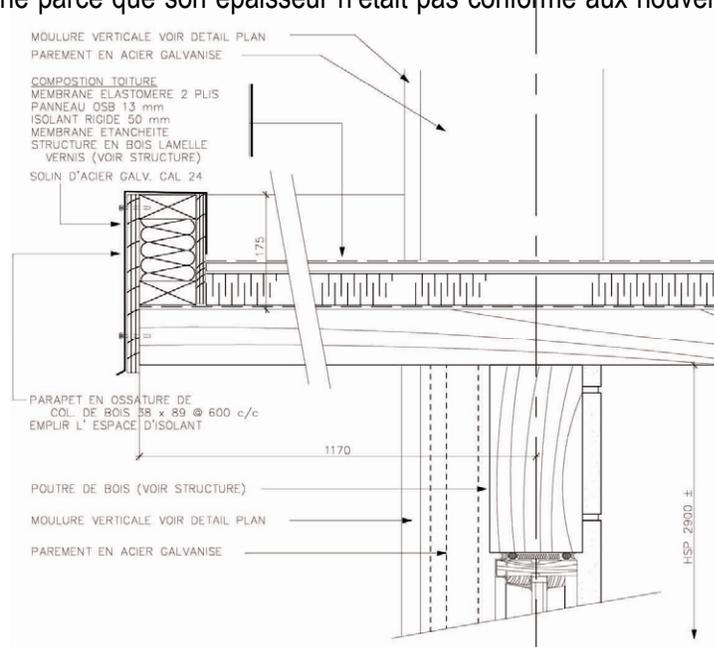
Détail de la toiture de planchéiage de madriers apparent (Source: Croft Pelletier Architectes).
